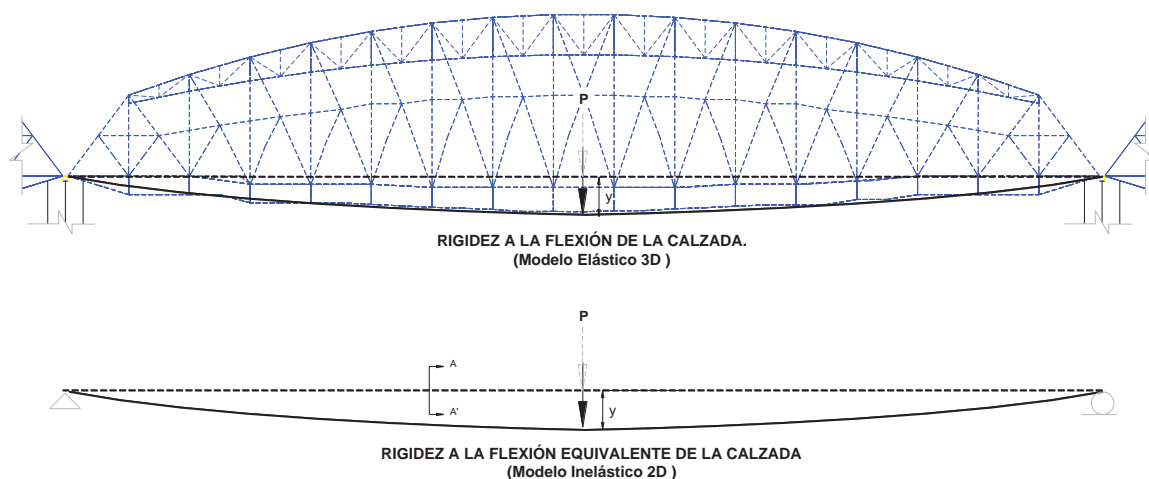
Determinación de la rigidez conjunta de la superestructura.
